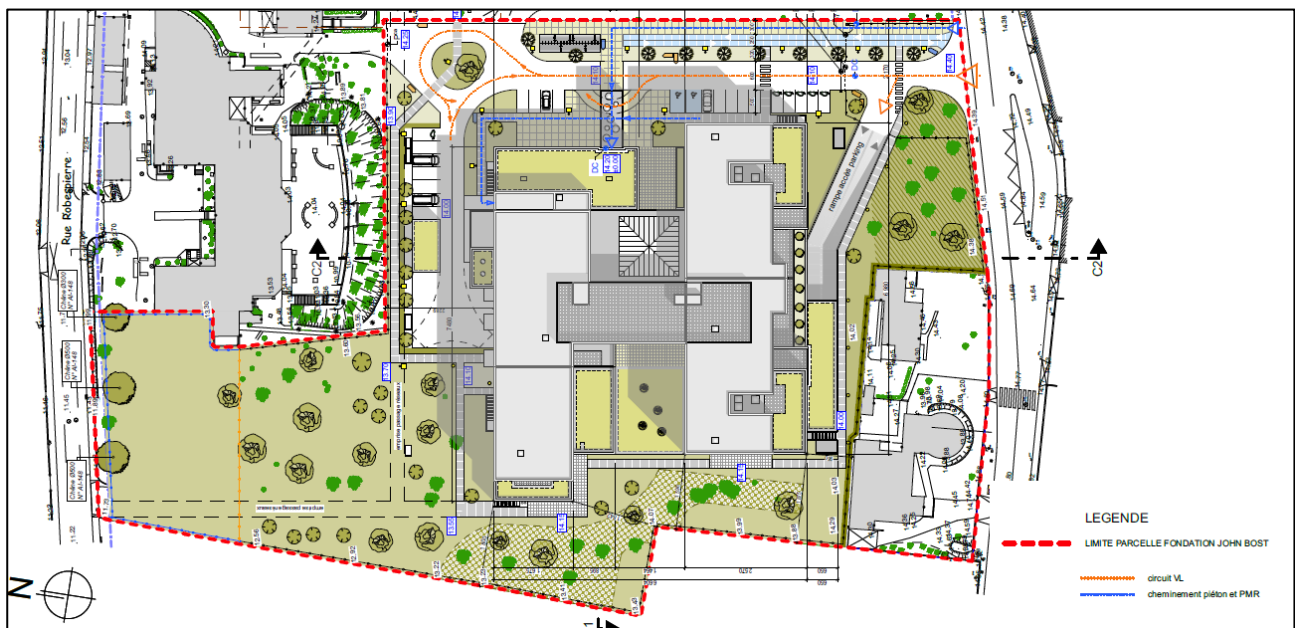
Plan masse du projet (source : Architecte DPLG)
